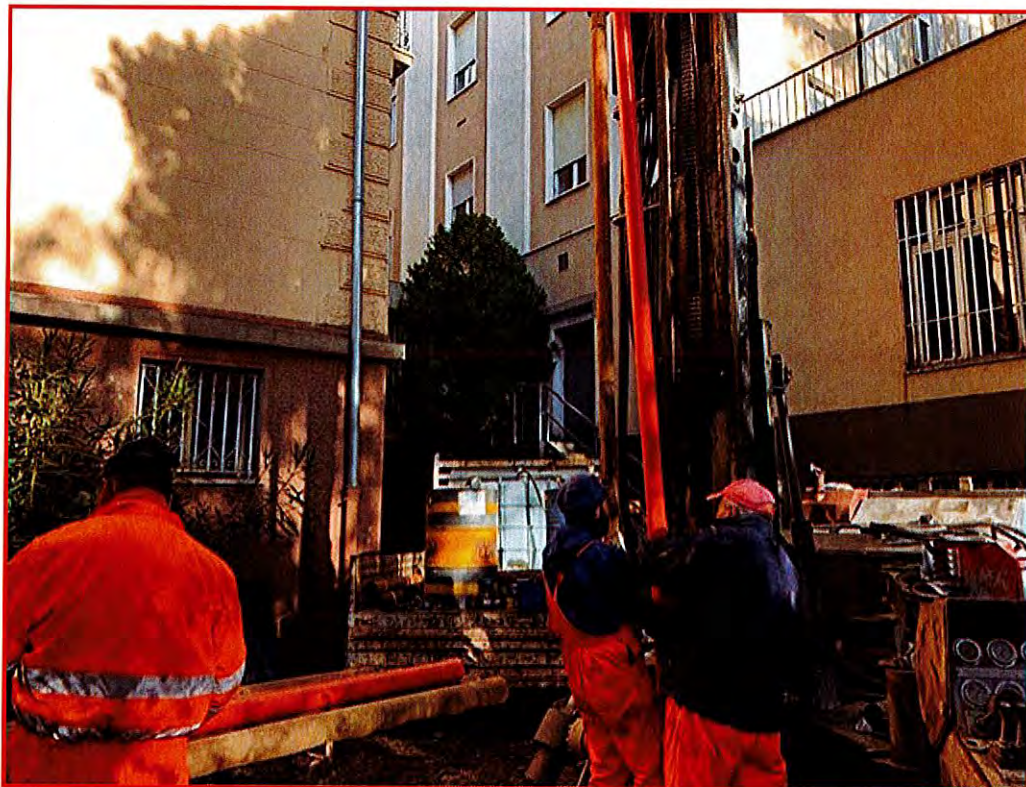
Installazione piezometro a tubo aperto nel sondaggio S3
